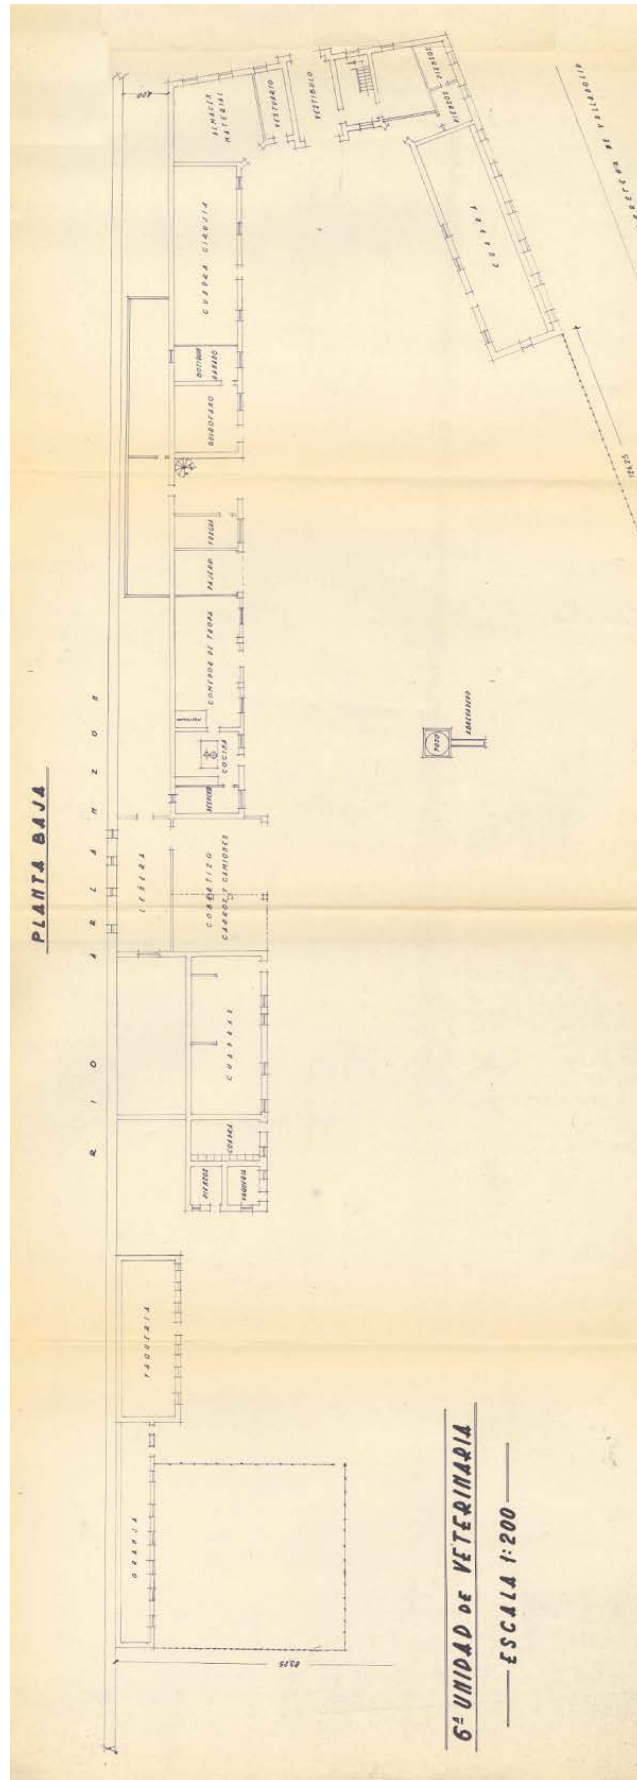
Plano de la planta baja del cuartel de Veterinaria (ca. 1960)
